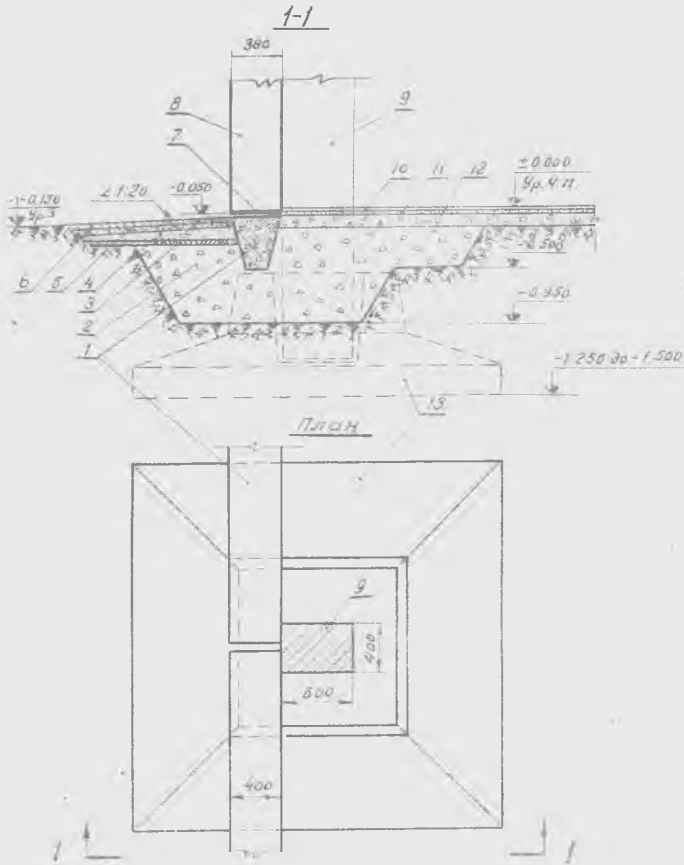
Сборный железобетонный ленточный фундамент под несущие стены.
